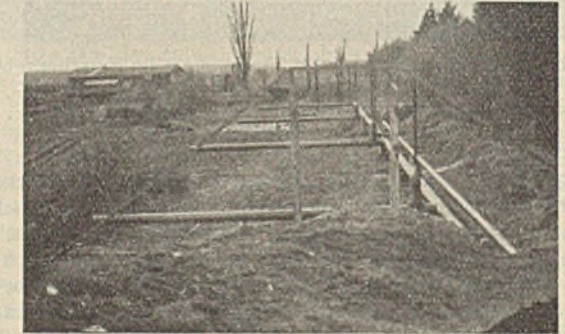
Erddamm im Bau für den Schlammfau raum in Frankfurt a. M.
